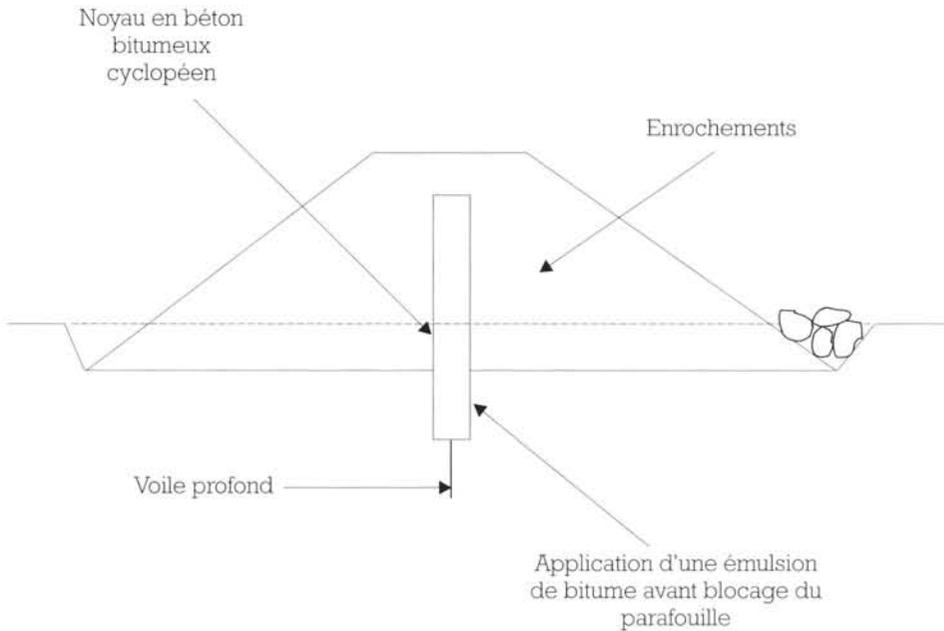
Barrage en enrochement à noyau interne en béton bitumineux cyclopéen.
